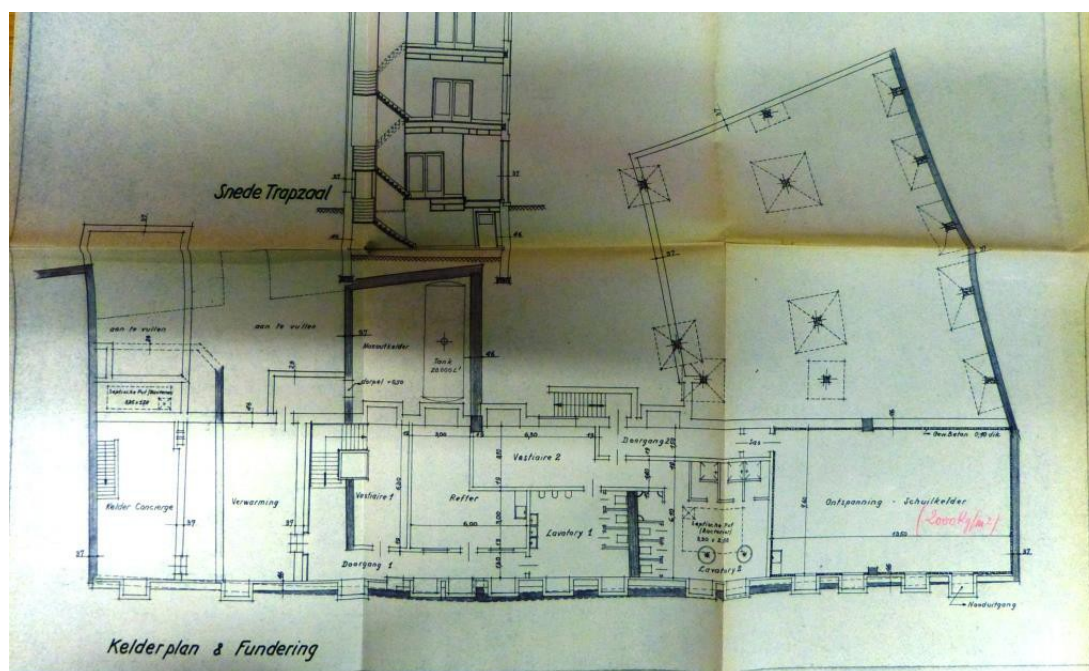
Kelderplan en funderingsplan uit 1953 (SAA 18#31119)
